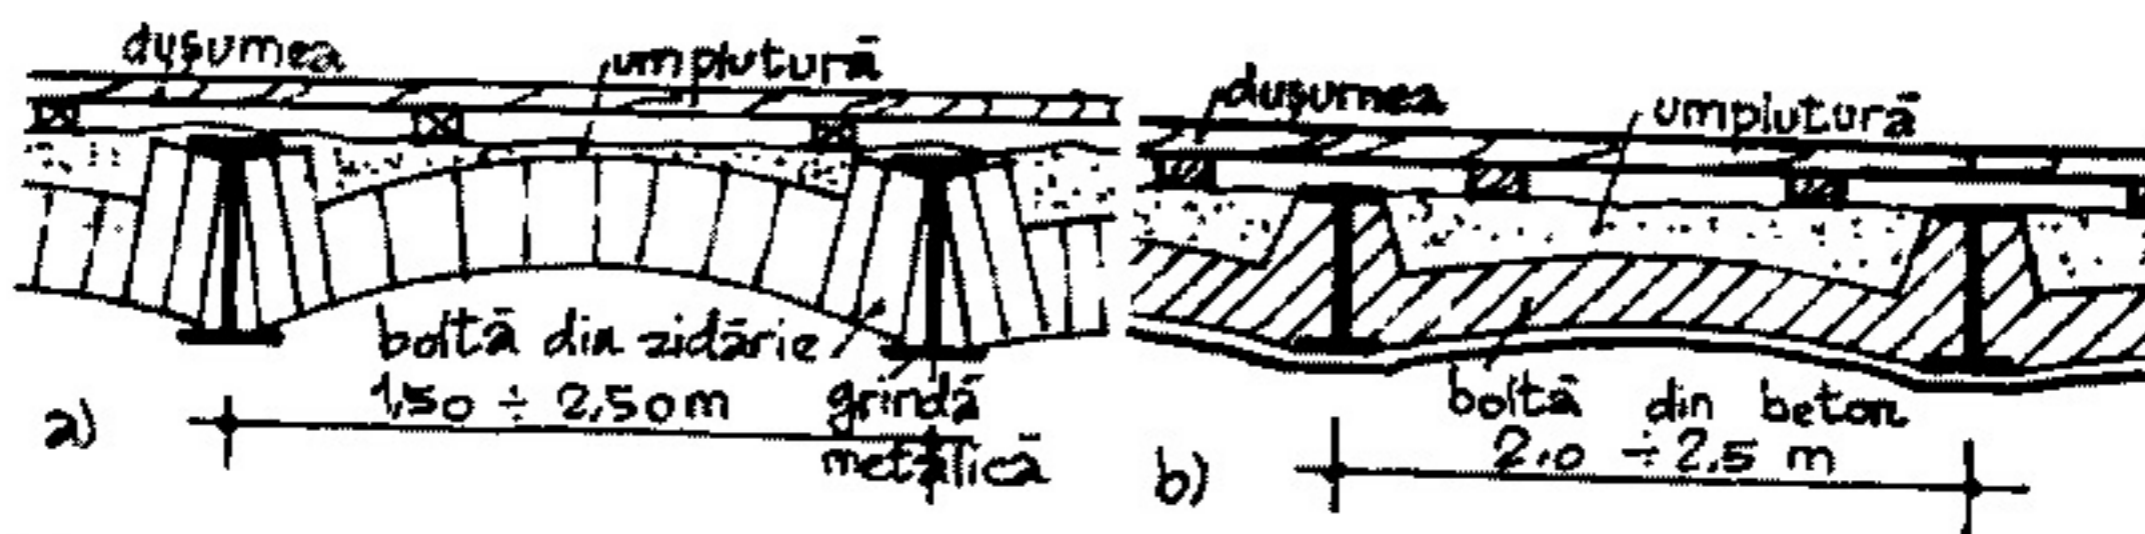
Planșee metalice cu: a - bolți din zidărie; b - bolți din beton monolit
